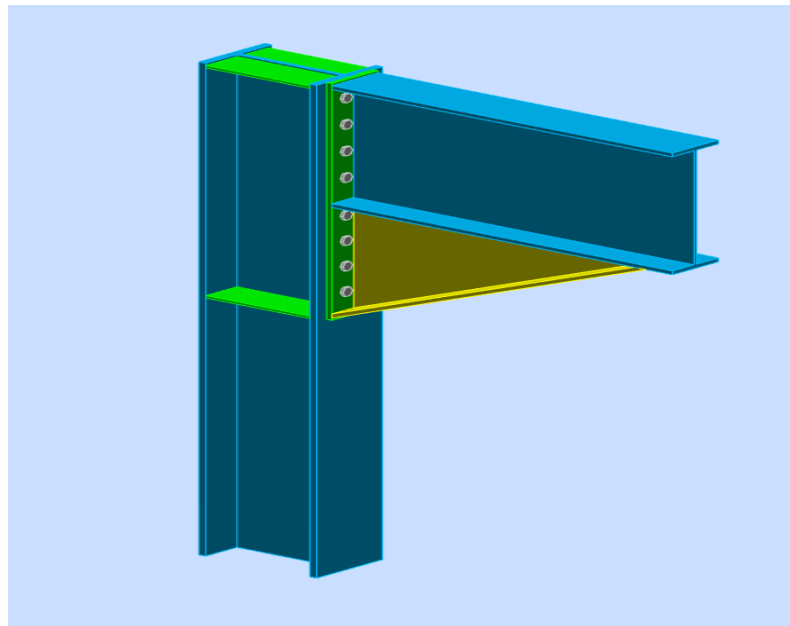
Assemblage Poteau –Poutre (HEB450-IP550).
